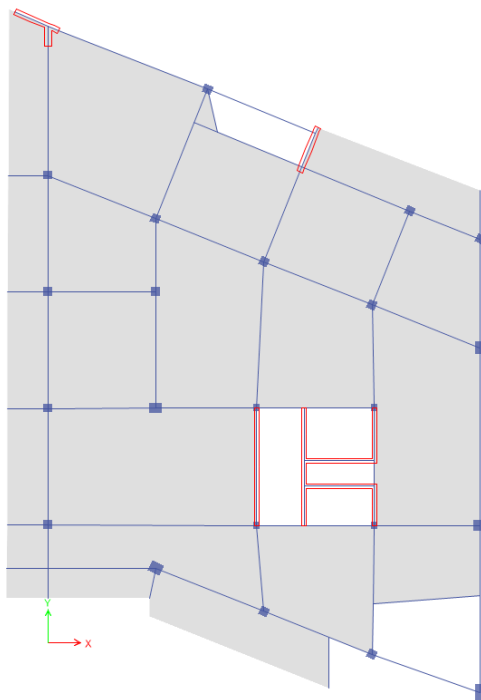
Distribución de elementos estructurales en planta (Losa Nivel 8)
